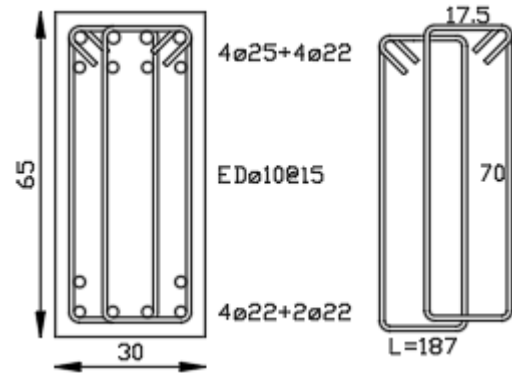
Vigas ejes 1 y 4, nivel 6-20. Edificio de 20 pisos.
